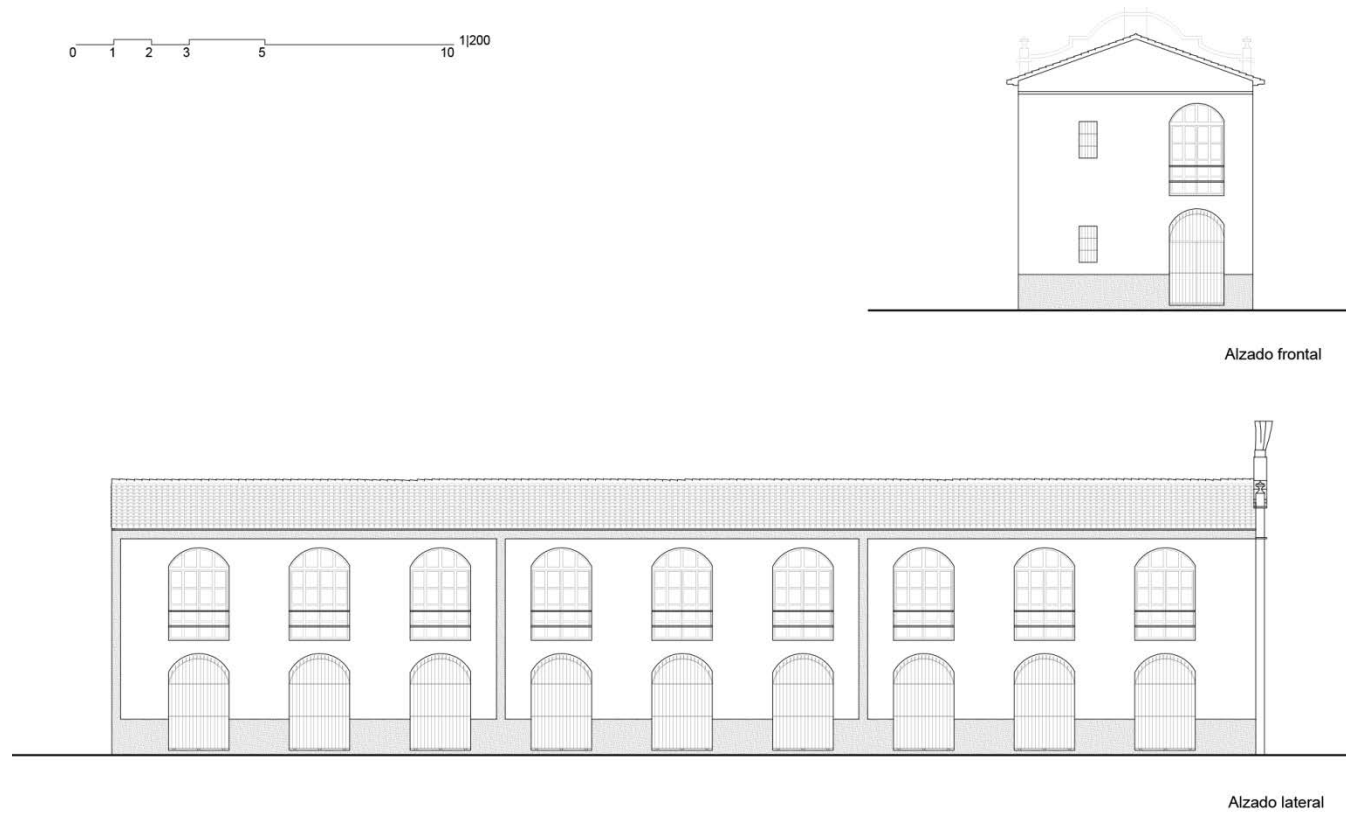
Levantamiento Planimétrico de Pabellón de San Rafael.
